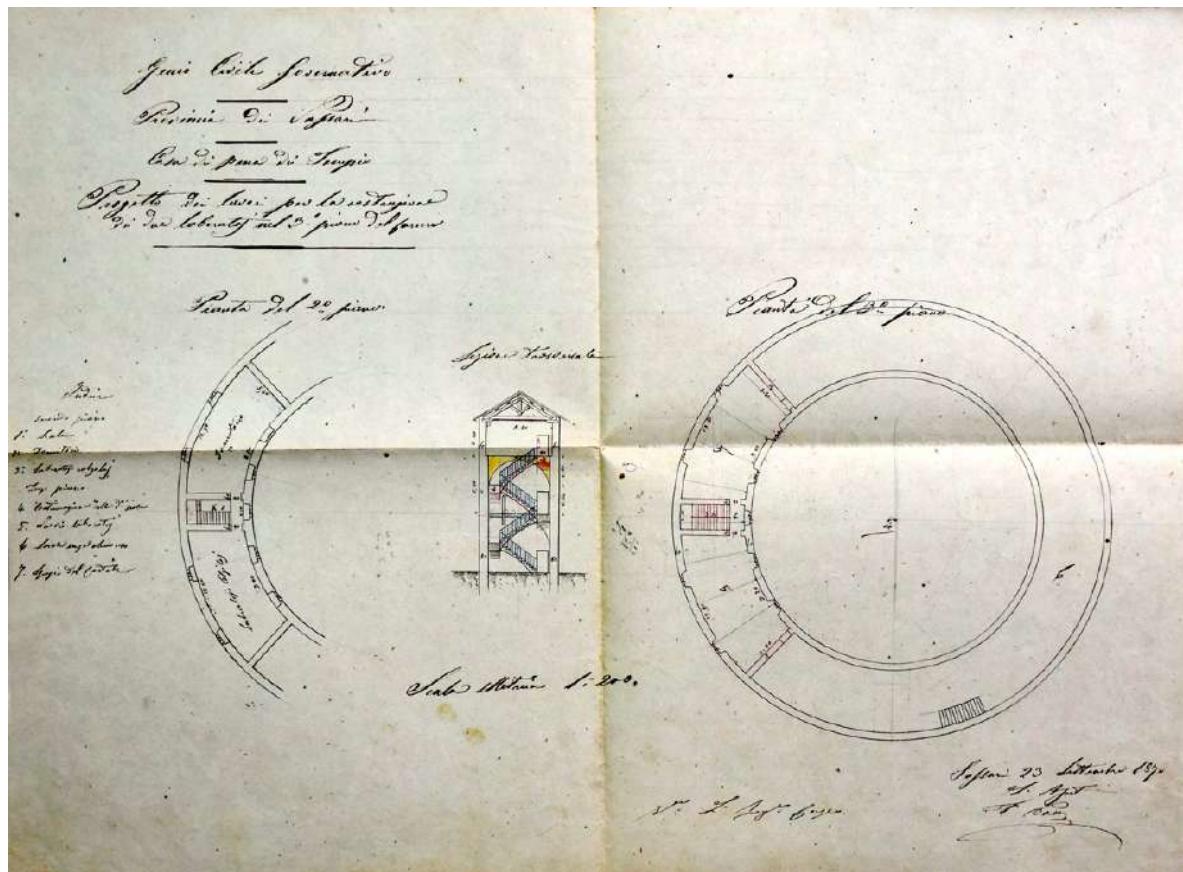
Pau, Progetto di sopraelevazione del carcere “La Rotonda”. di Tempio Pausania, 23 settembre 1870. *Progetto dei lavori per la costruzione di due laboratori nel 3° piano del carcere. Pianta del 2° piano; sezione trasversale e pianta del 3° piano.* ASGCS, cart. 1/116, Carceri Giudiziarie di Tempio, 1/A, Disegni.
